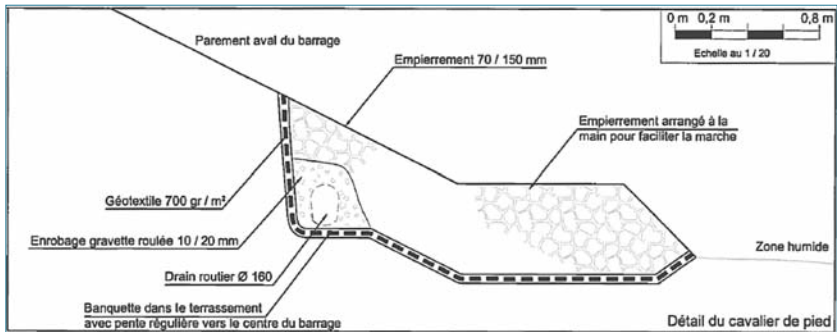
Profil en coupe du système de blocage et filtre-drain en pied d'ouvrage (source : CD 38 et Géo+).
